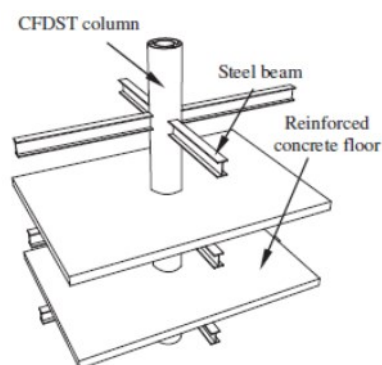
Vista esquemática: Columna de doble piel en edificación (Li, W. y col., 2012a).
